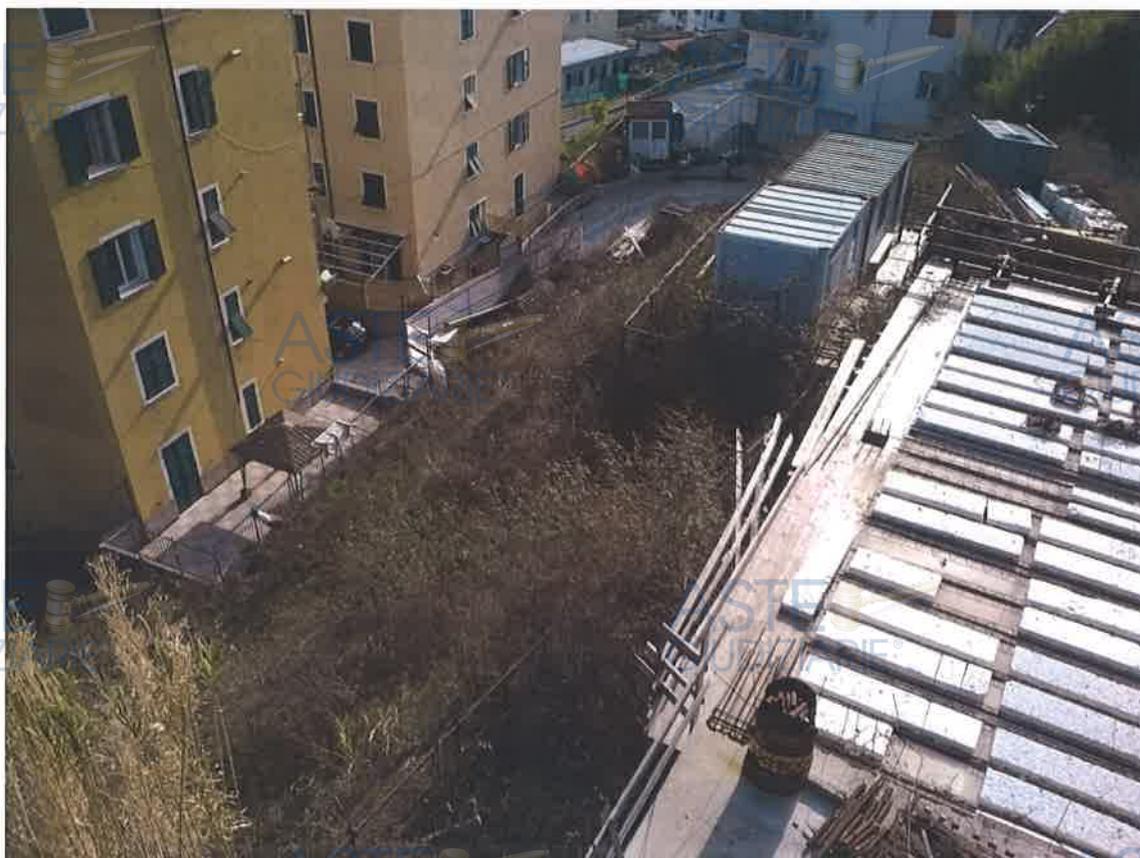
panoramica dall'alto delle sistemazioni fra edificio e confine proprietà a valle
